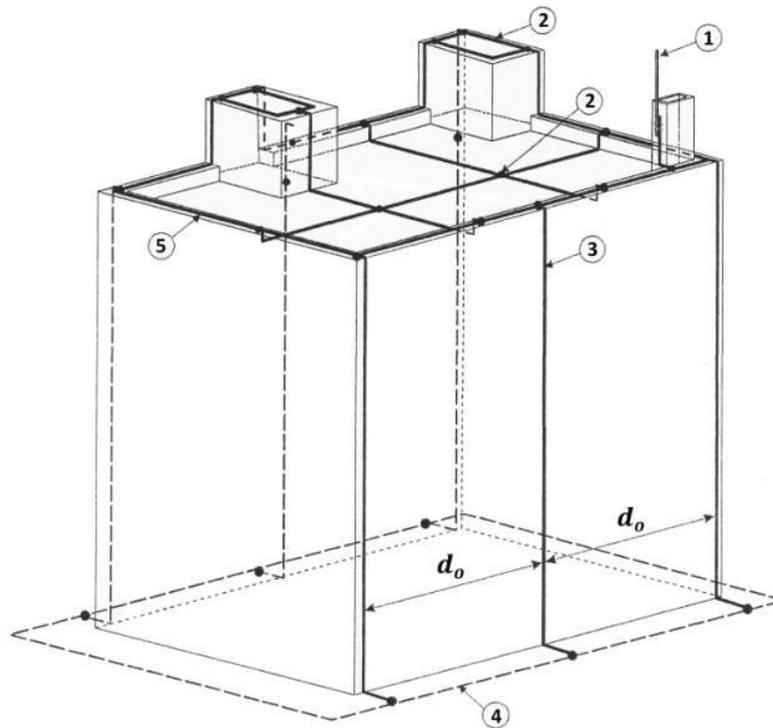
Arreglo físico representativo de la conexión entre terminales aéreas, conductores de bajada y un arreglo cerrado del sistema de puesta a tierra en un edificio con diferentes alturas en el techo y para un sistema no aislado de protección.
